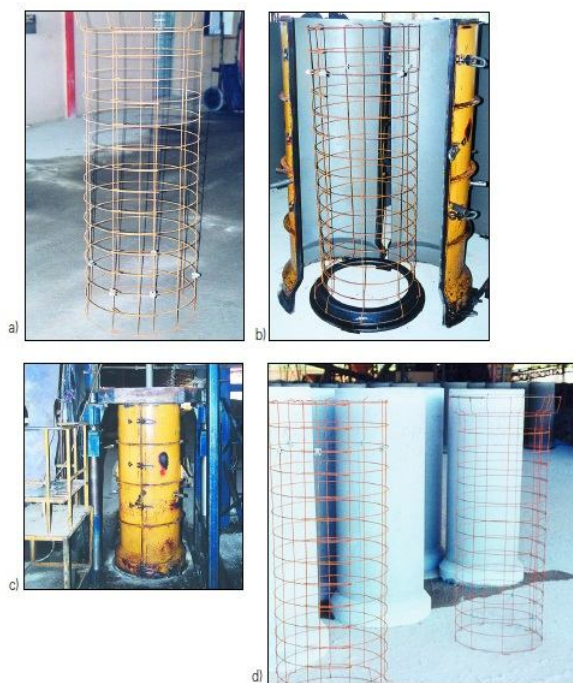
Fabricação tubos circulares de concreto armado
